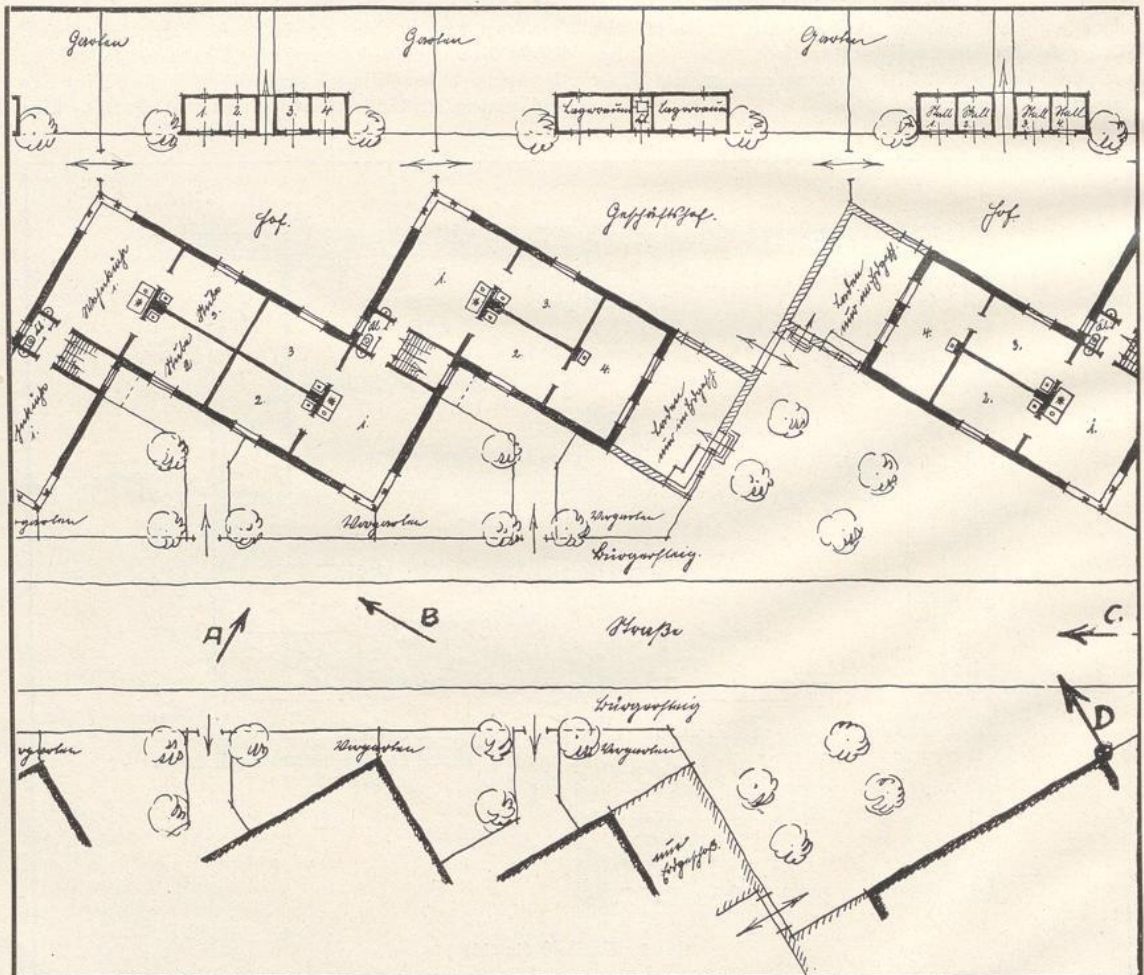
Straße mit schräggestellten Häusern (1:400)
